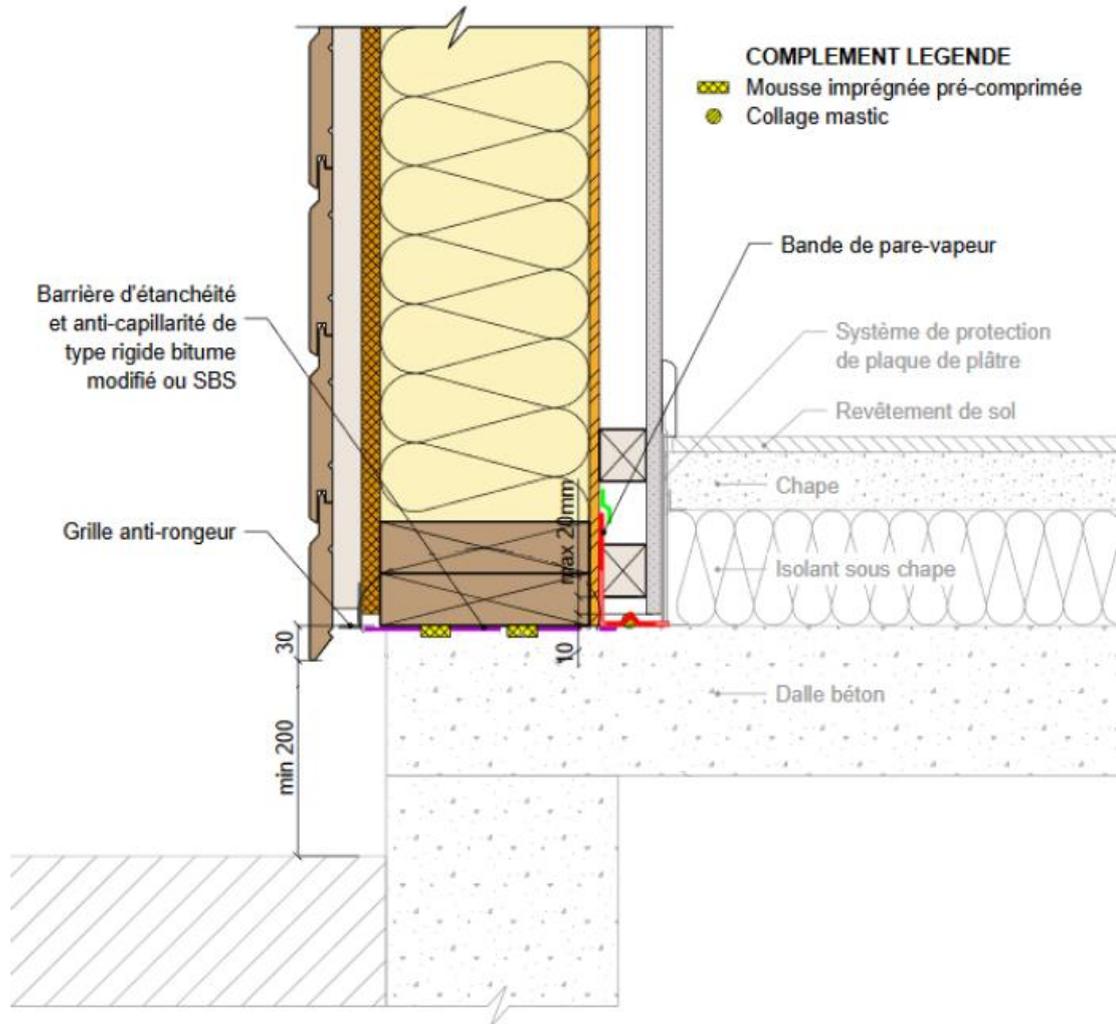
Exemple de raccords en pied de mur (coupe verticale)
